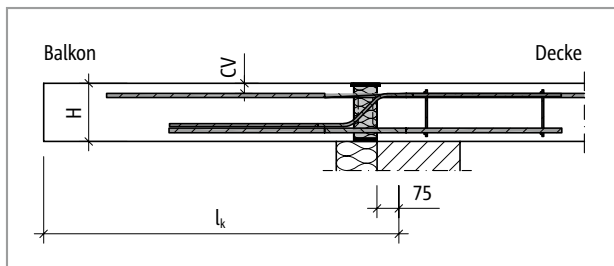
Schöck Isokorb® T Typ K-M13 bis M14: Statisches System
